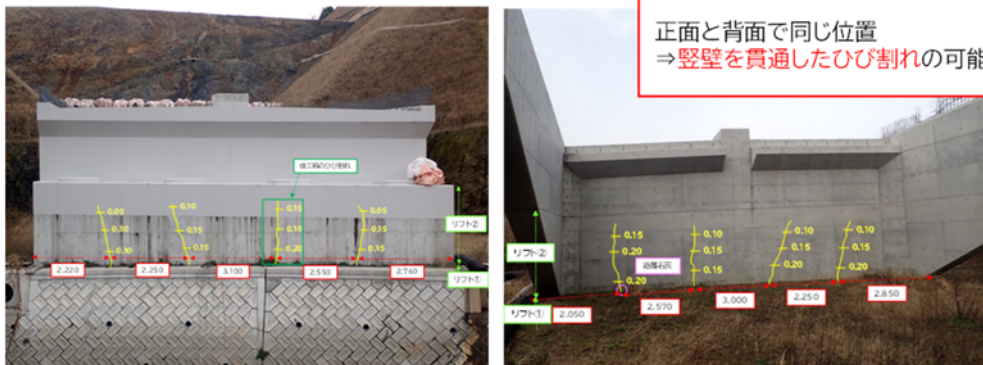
設計段階で照査しなかったコンクリート構造物のひび割れ発生事例
